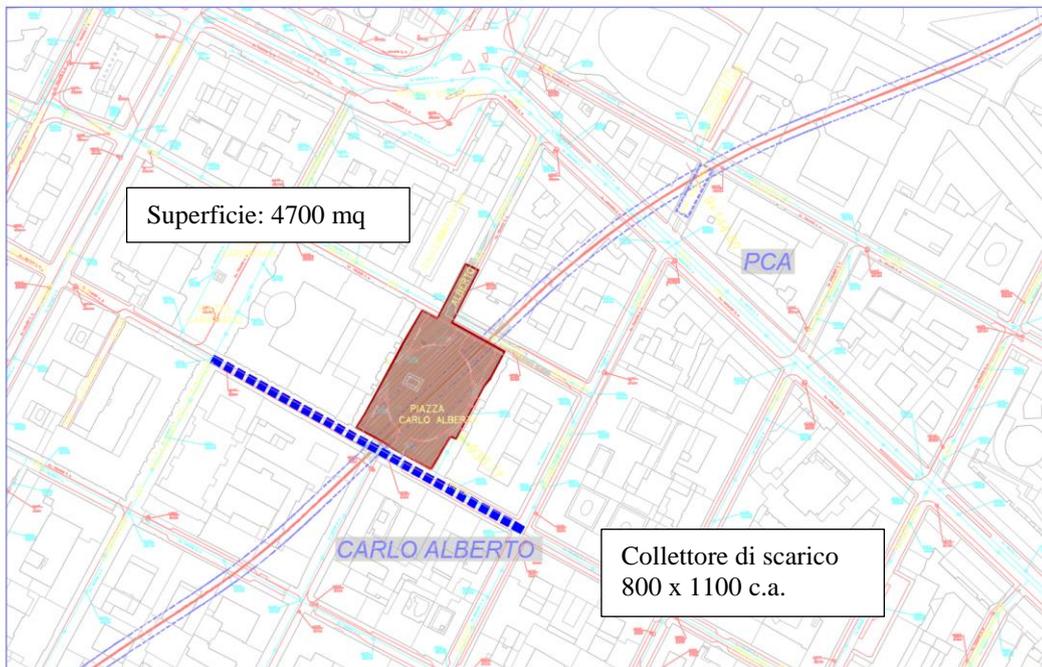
Aree di cantiere – Stazione Carlo Alberto – FASE 2B
